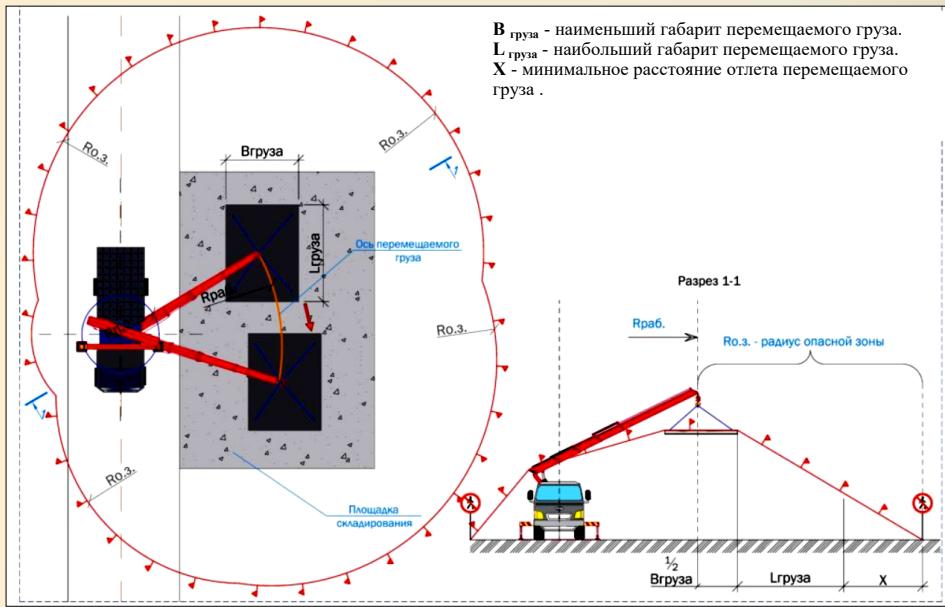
Границы опасной зоны от падения груза при его перемещении ПС (кранами, трубоукладчиками)
